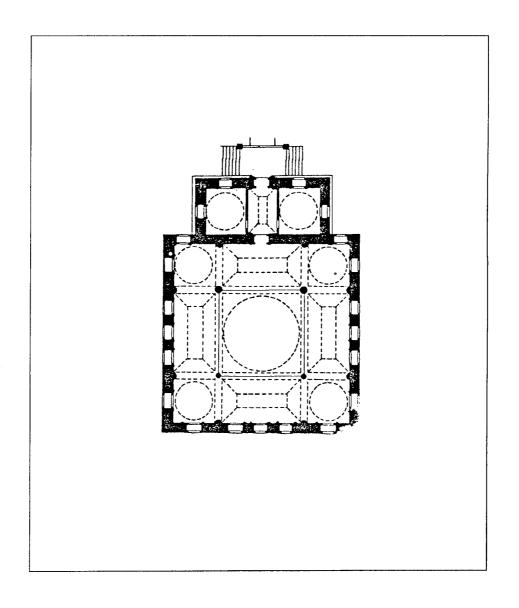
مسقط أفقي لمسجد ومدرسة سوكللو محمد باشا في لولى بورغاز (Cezar) .
